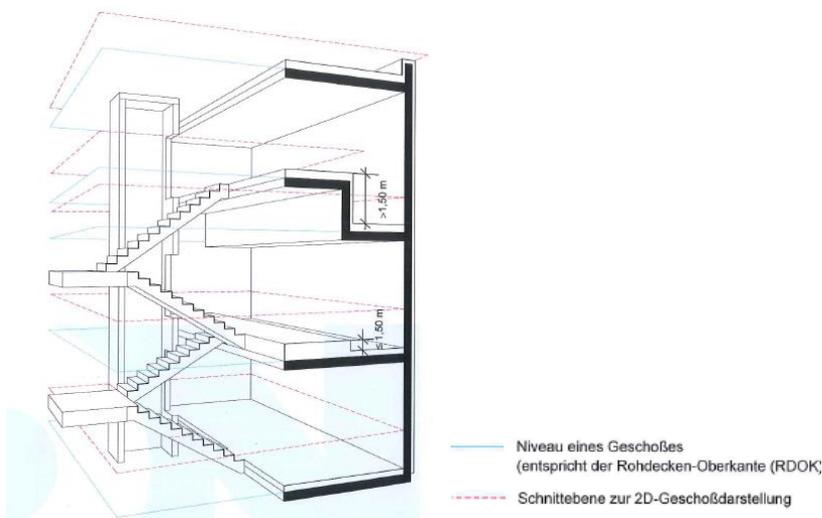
Modellierung von Geschossen gemäß ÖNORM 6241-2 <sup>89</sup>
